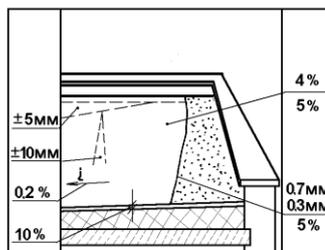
Схема допускаемых отклонений при приемке основания кровли
